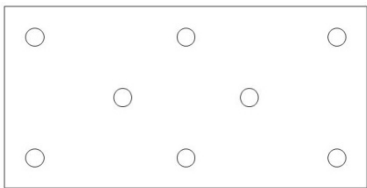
Plans de chevillage – panneaux de dimensions 1000 x 500 mm
